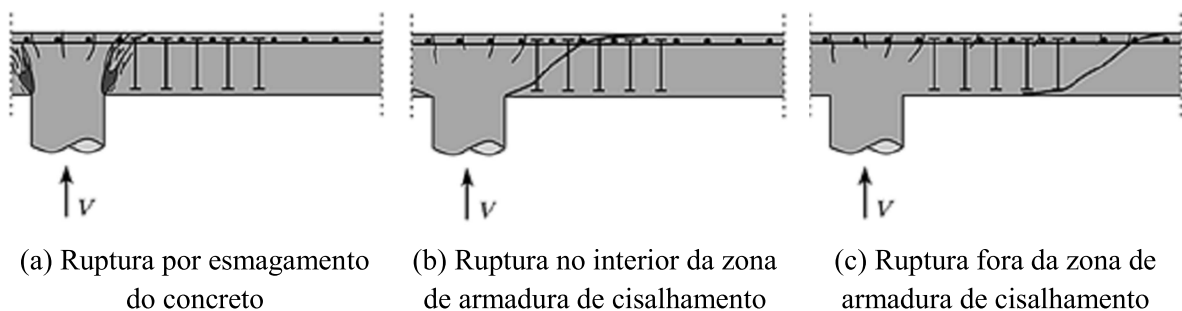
Modos de ruptura de lajes lisas com armadura de cisalhamento (Ruiz e Muttoni, 2009)
